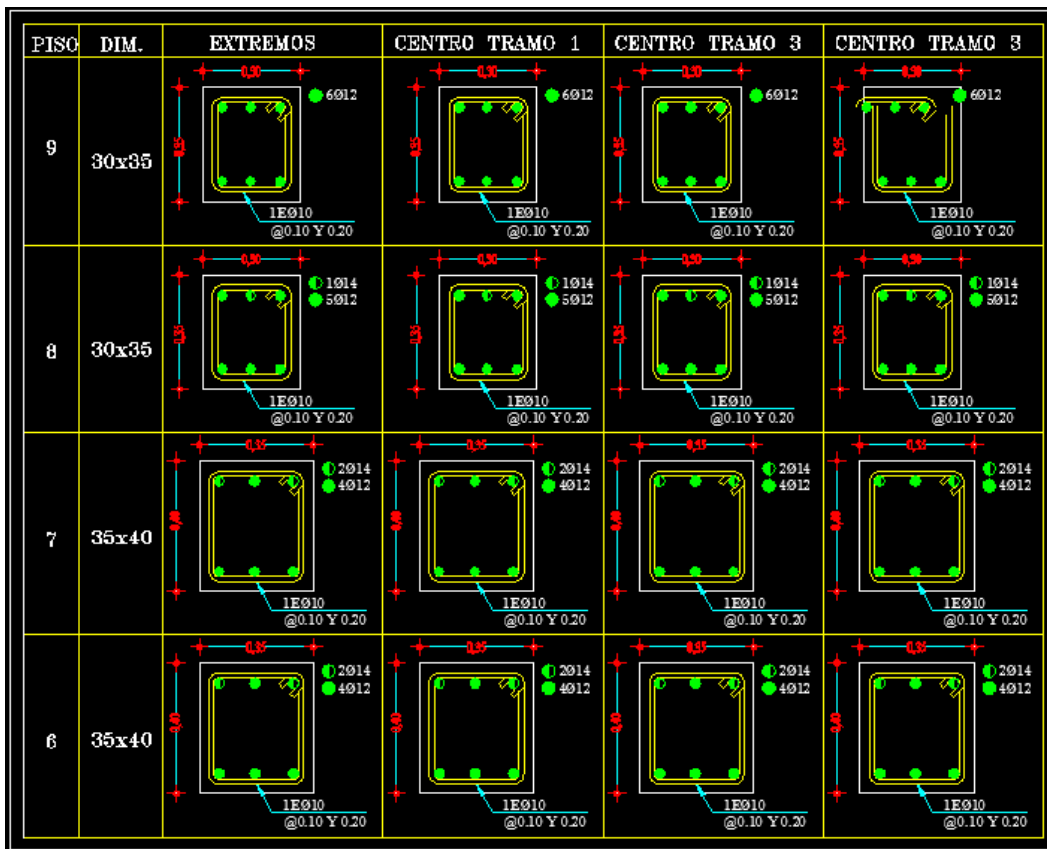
Armadura de las Vigas Edifi. 9 Pisos
